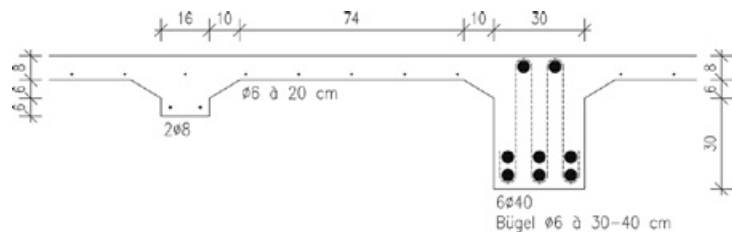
Bewehrung eines Plattenbalkens im Erweiterungsbau der LMU (JR; Vorlage Bewehrungsplan Fa. Leonhard Moll, 1907; BSA, Uni 42). M 1:25.
